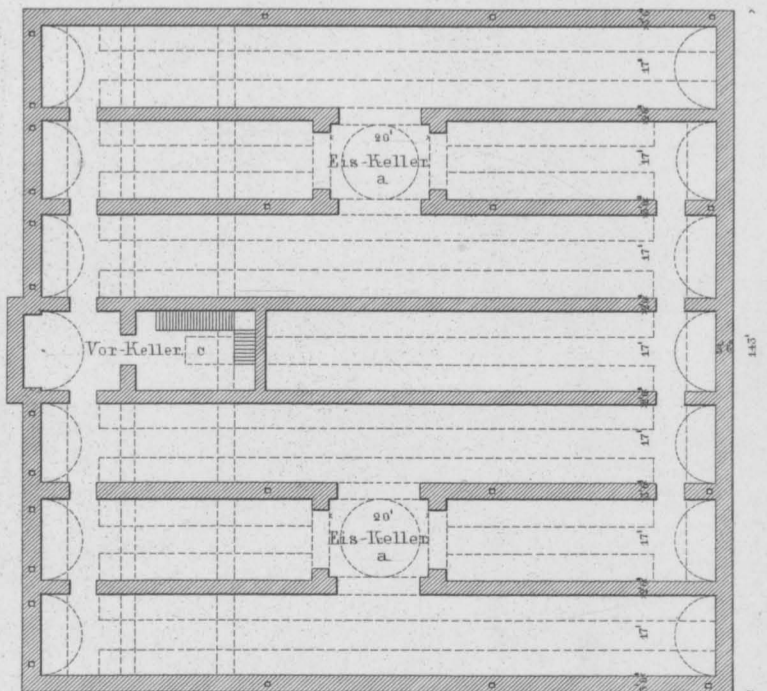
Grundriss des Sommer-Bier-Kellers.
